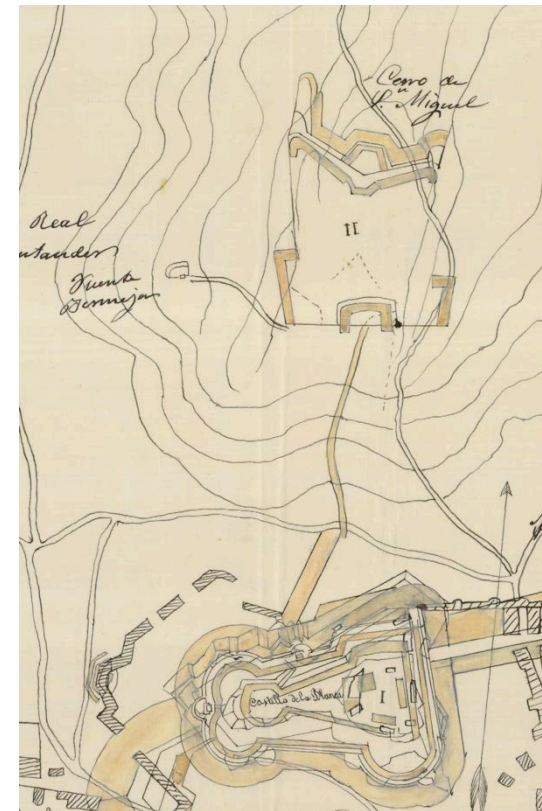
Detalle del <<Plano de 1858 donde se aprecia el castillo>>
